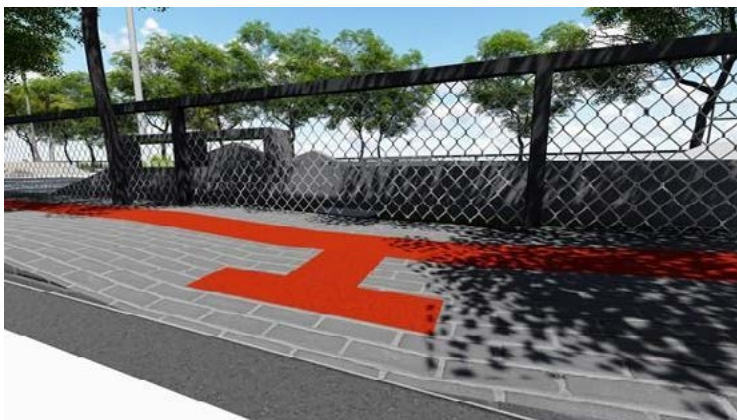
Revitalização – Rebaixamento de calçada. Fonte: Autoria própria, 2022
